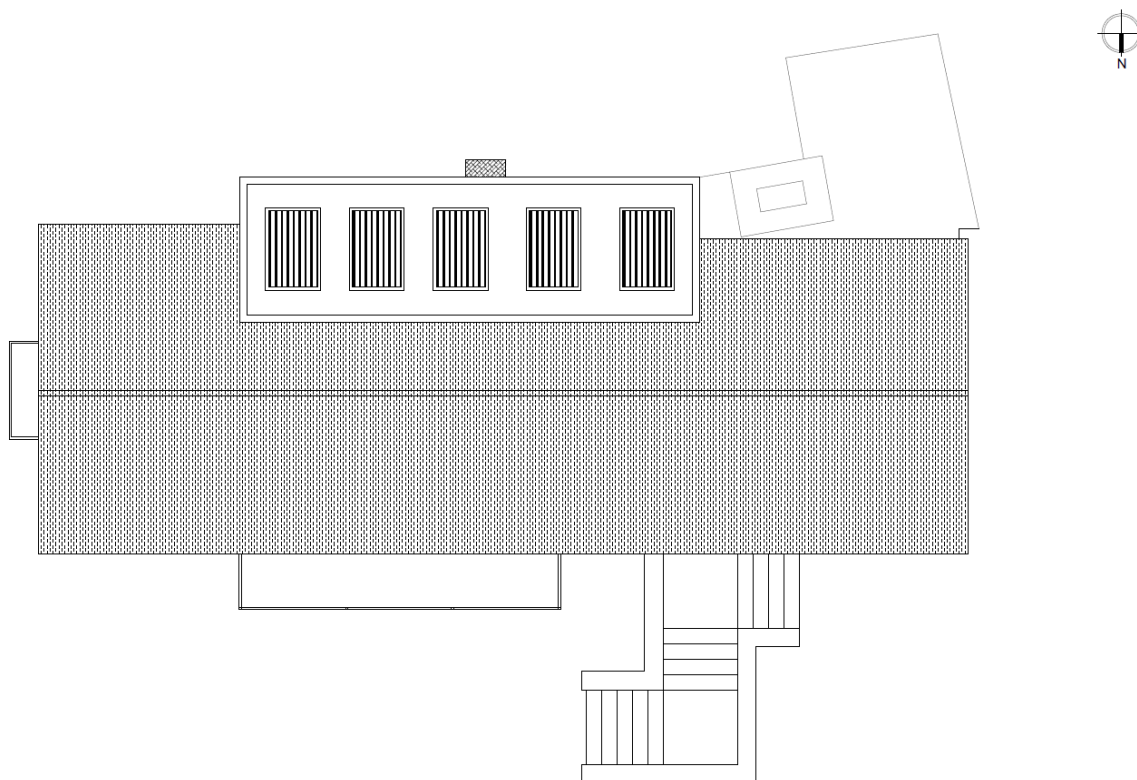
Planta de Cobertura, Alojamento Branqueiro e Alojamento Loureiro.
